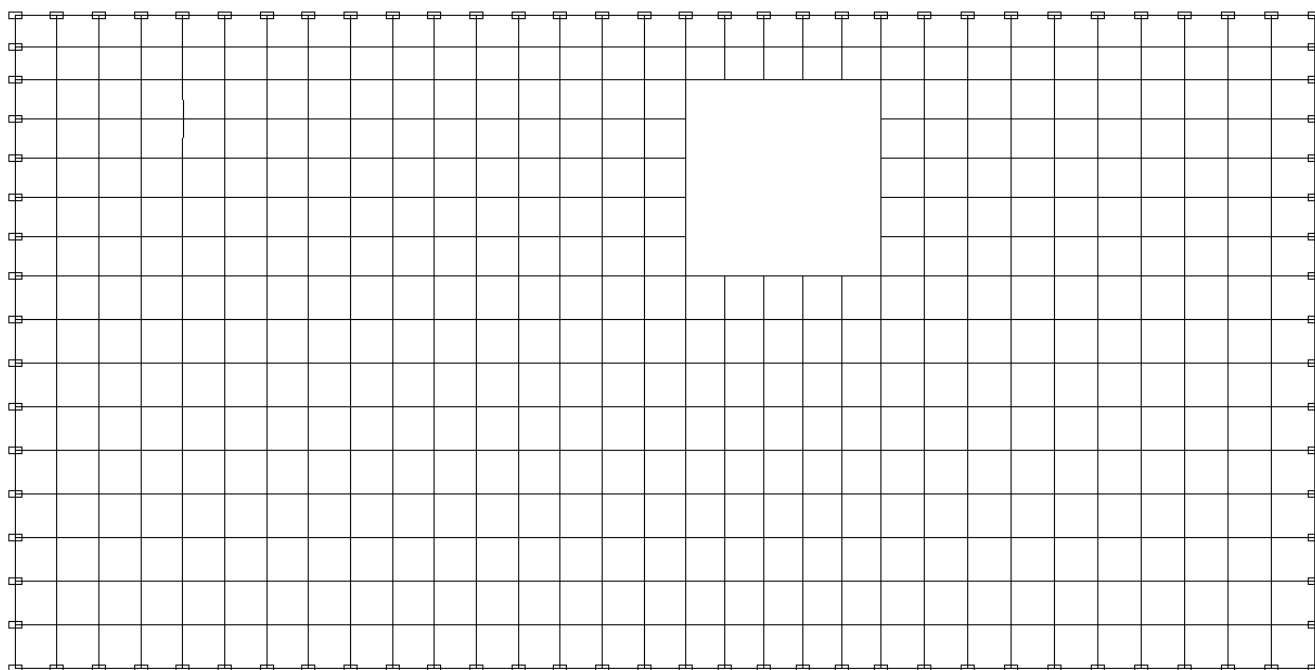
Расчетная схема плит перекрытия и покрытия
